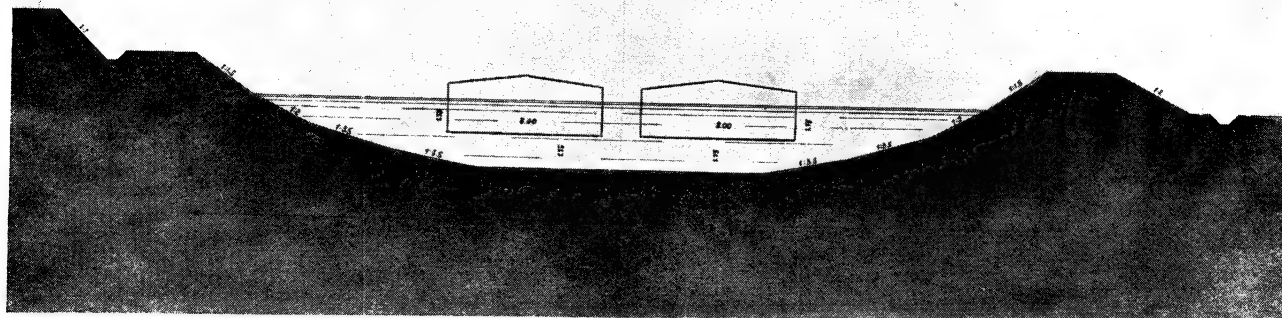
Profilul transversal al canalului Tei-Fundeni.
